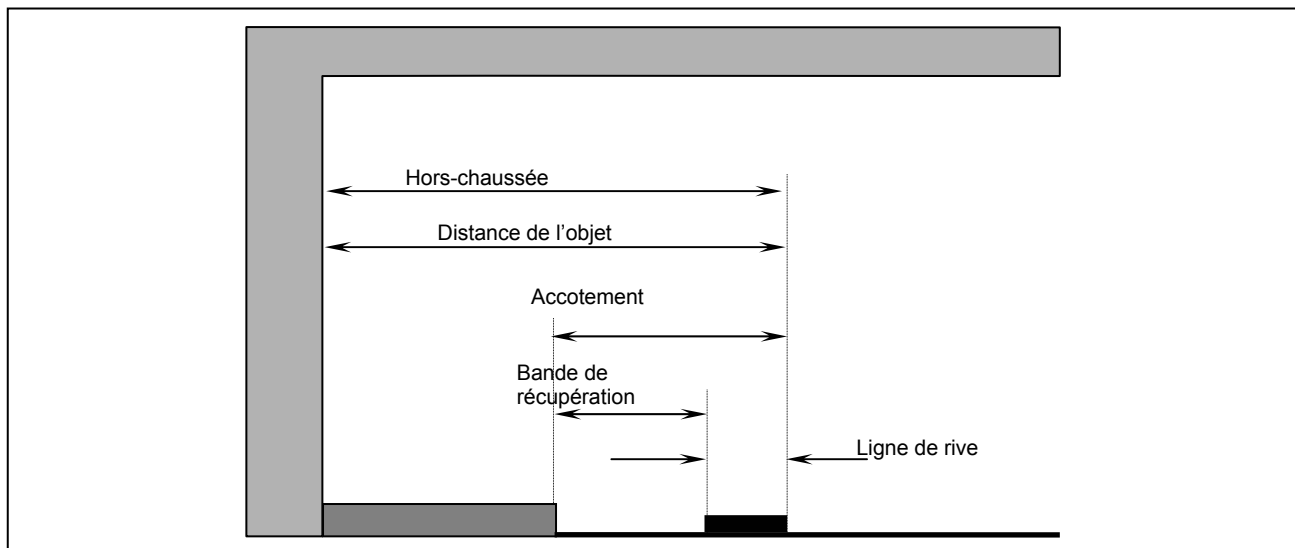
Éléments et fonctions d'une zone hors-chaussée avec trottoirs
